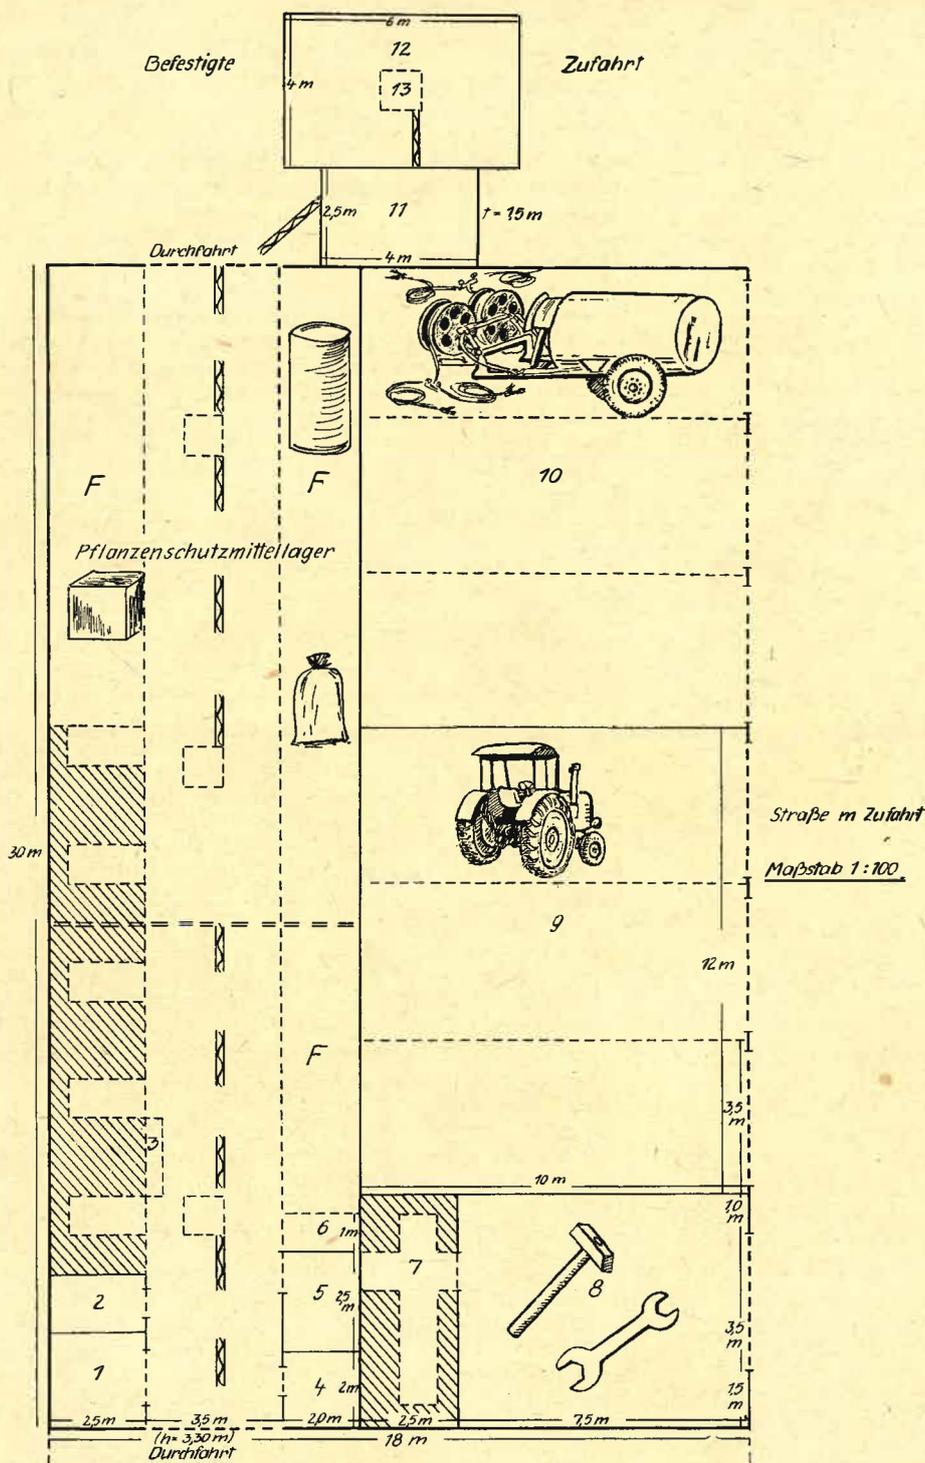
Stützpunkt für Pflanzenschutzmittel und -maschinen
